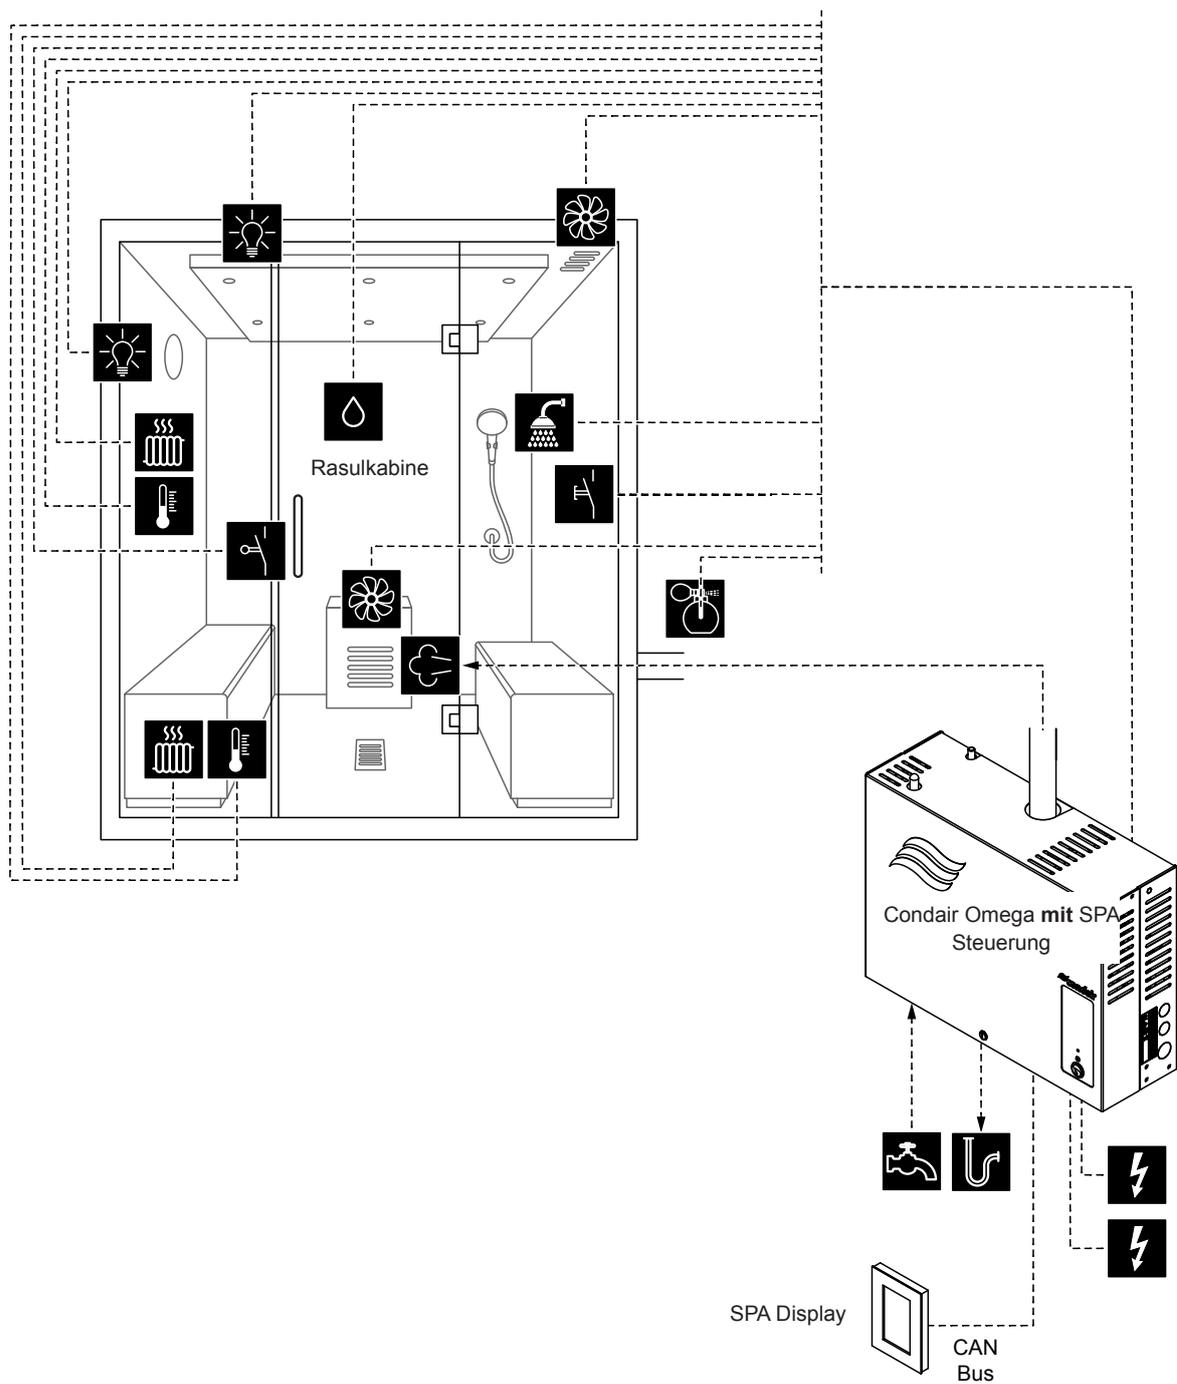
Condair Omega mit SPA Steuerung und Ausrüstung für Rasulanwendung
